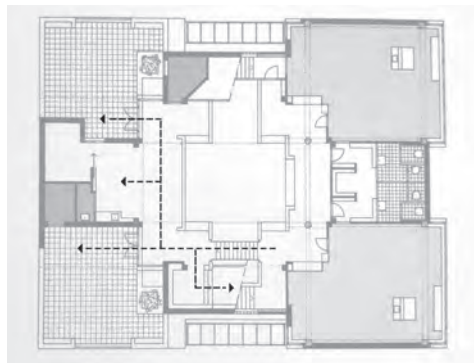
Erschliessungsnetz innerhalb der Apollo Grundschule: Klassenzimmer und Halbggeschoss mit Dachterrassen.
